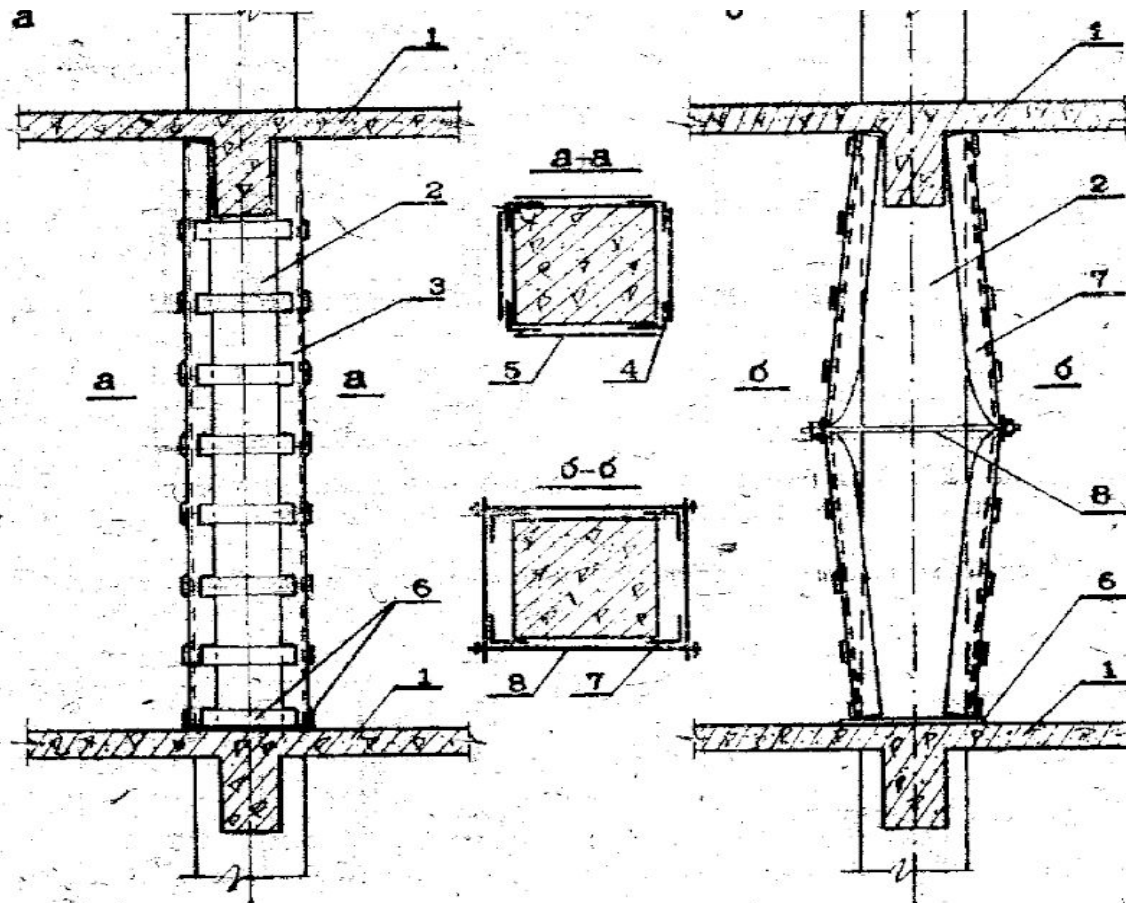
Усиление железобетонных колонн многоэтажных зданий
